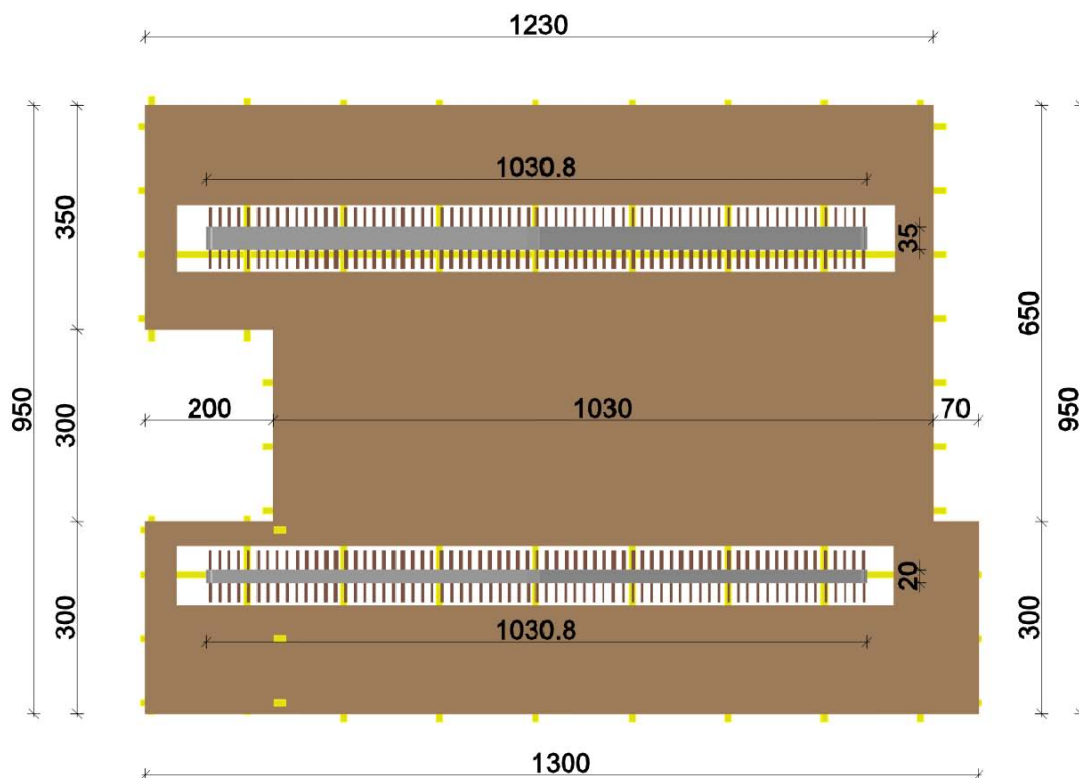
Grundriss der Arbeitsbühne
